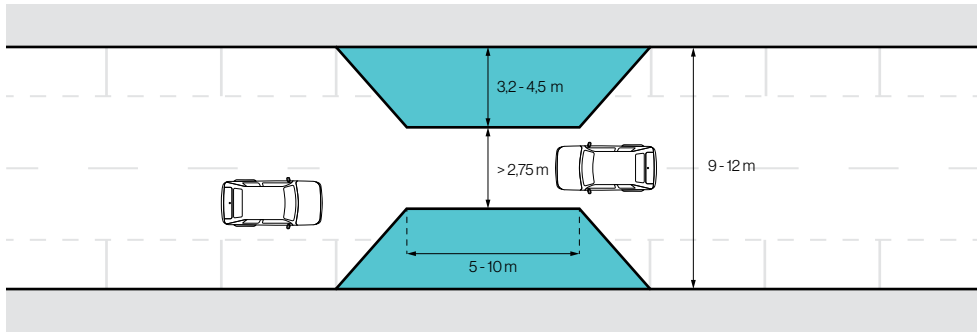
Ejemplo de estrechamiento en sección con paso alternado, aplicado en vía con calzada entre 9 y 12 m.
